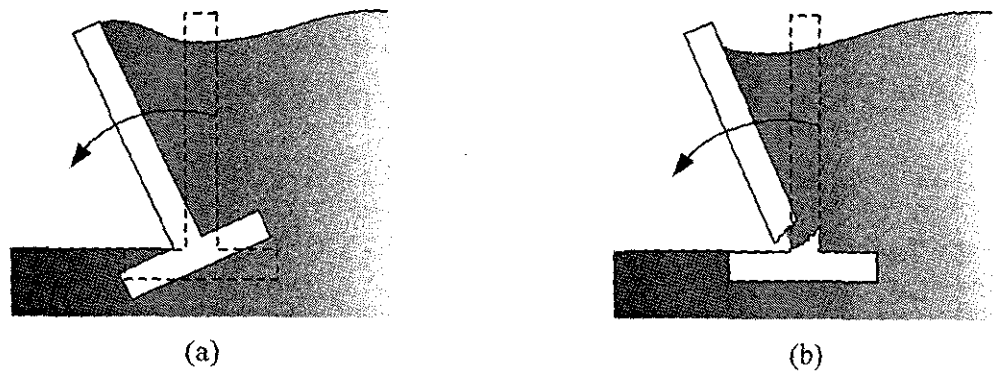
ลักษณะทั่วไปของกำแพงกันดินชนิด Cantilever wall
